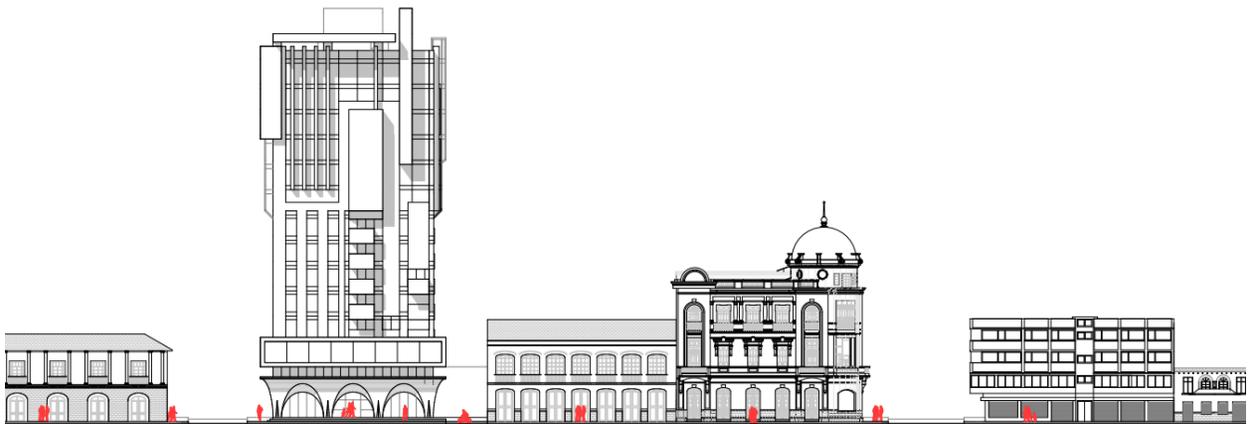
Fachada planificada España. Fuente: Tesistas.
